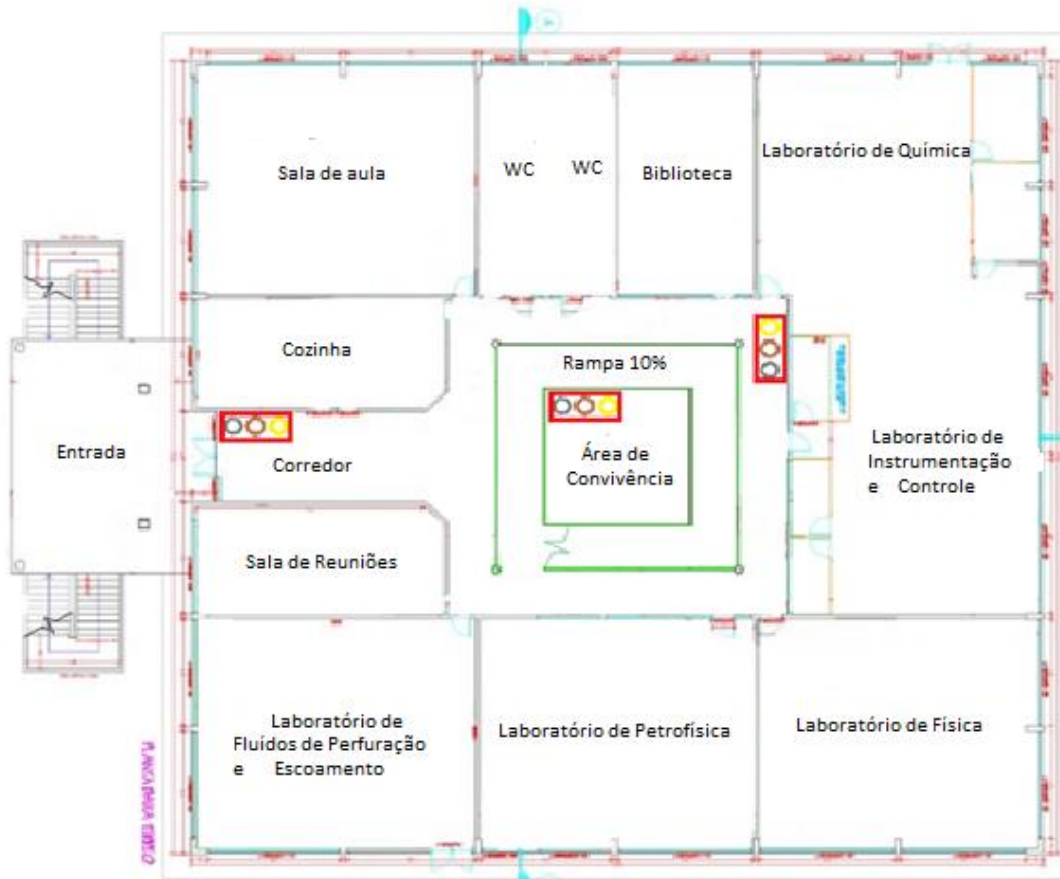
Localização das lixeiras na planta baixa do 1º andar
